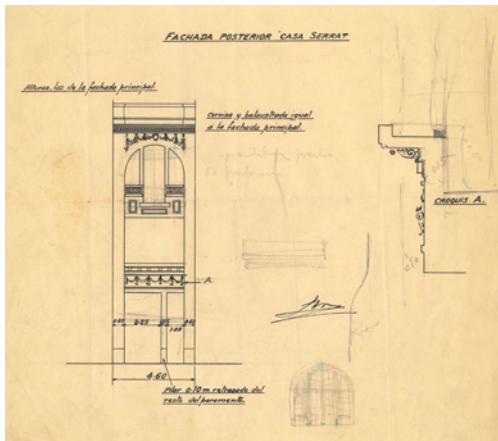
Fachada posterior de la Casa Serrat. Archivo Lorenzo Ros.
